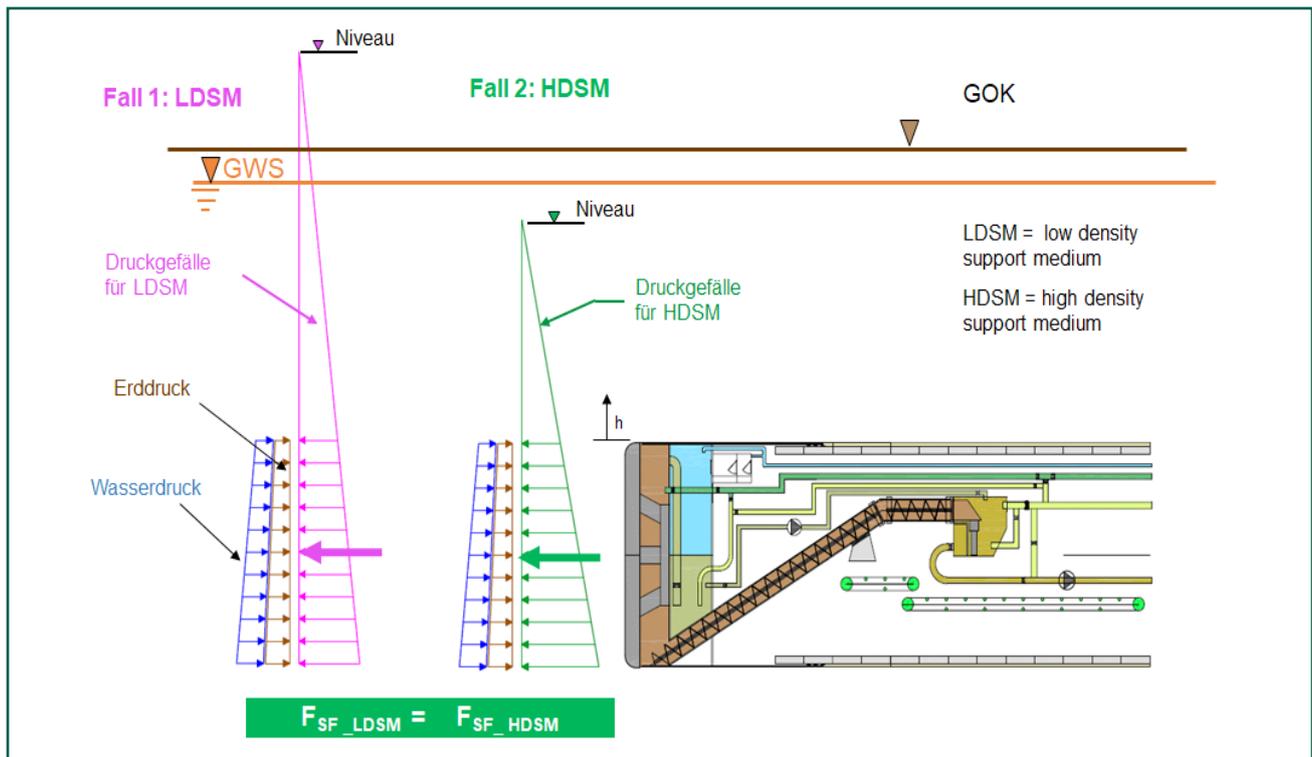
Druckgradienten des Stützdrucks in der Abbaukammer für die Standard-Suspension (LDSM) und die Suspension mit erhöhter Dichte (HDSM) [53]
